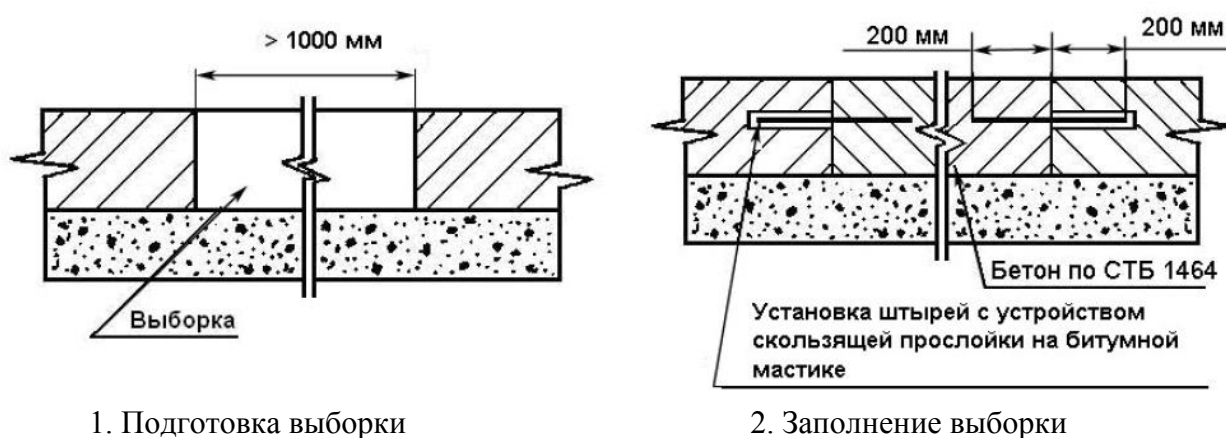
Частичная замена плит цементобетонного покрытия
